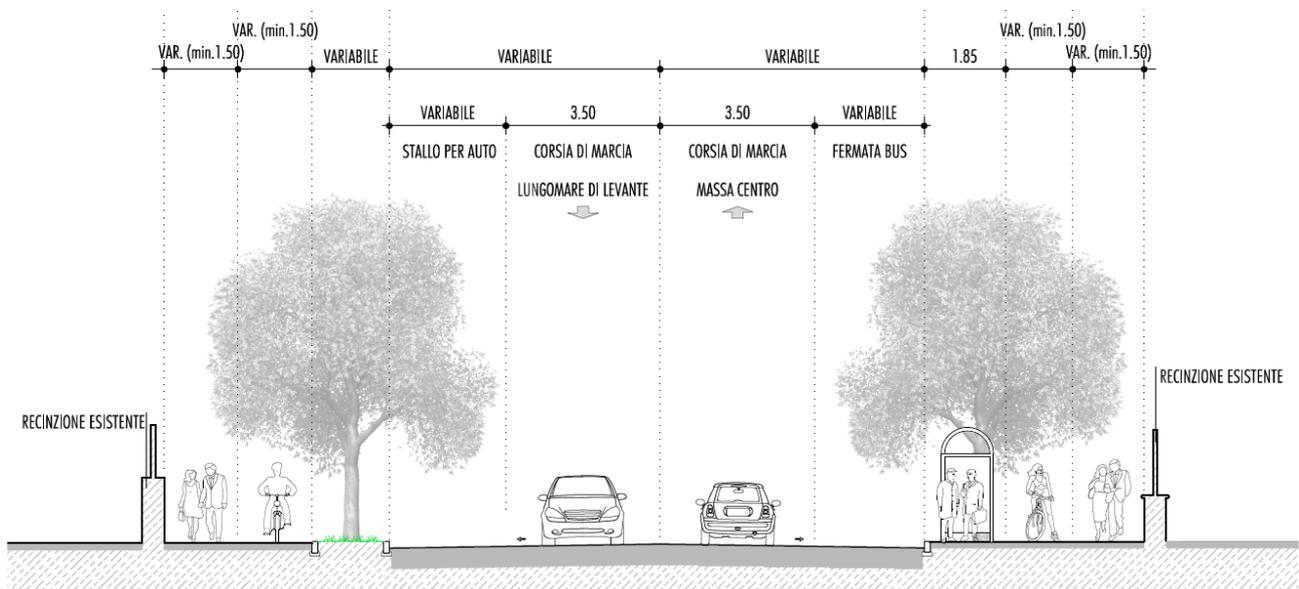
VIALE ROMA – SEZIONE TRASVERSALE TIPO
